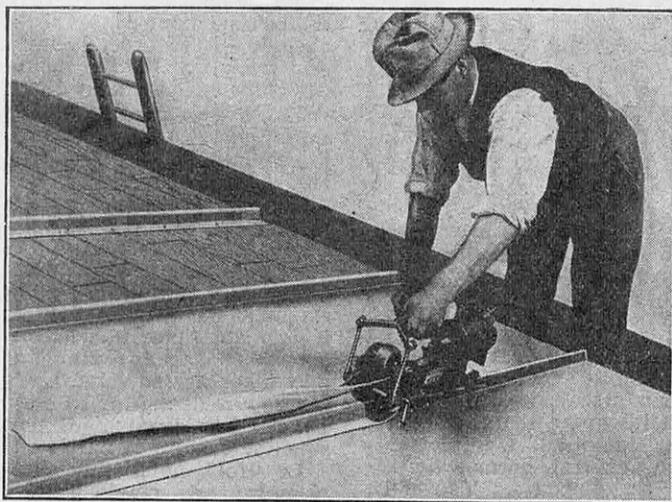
POSE A LA MACHINE D'UN COUVRE-JOINT
